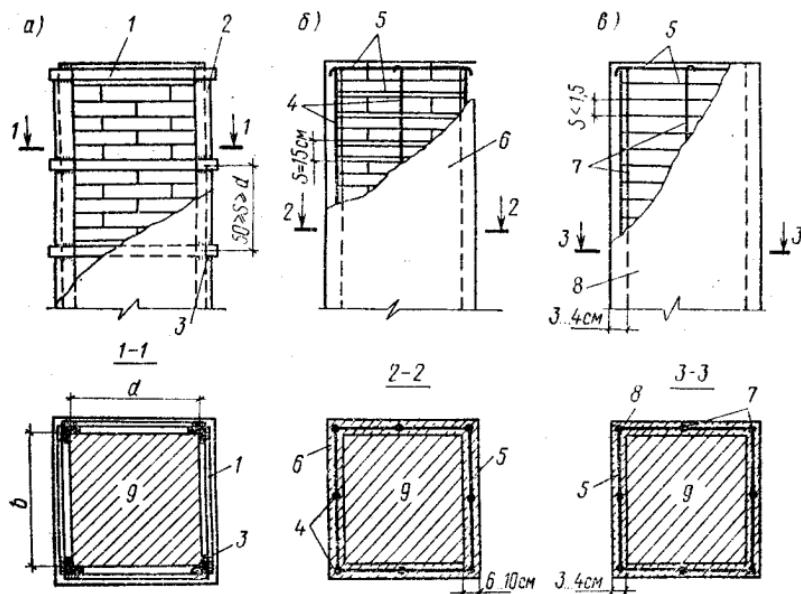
Усиление каменных столбов стальной (а), железобетонной (б) и армированной растворной (в) обоймами:
